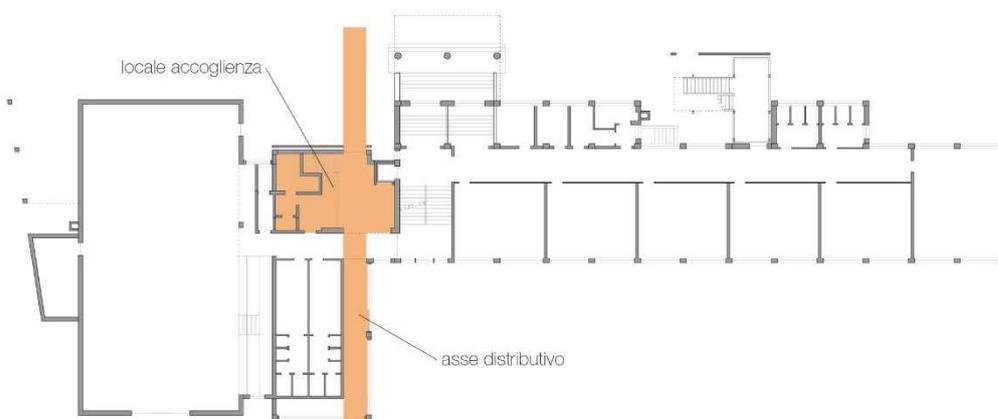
schematizzazione dell'intervento di passaggio dell'asse al piano terra.
